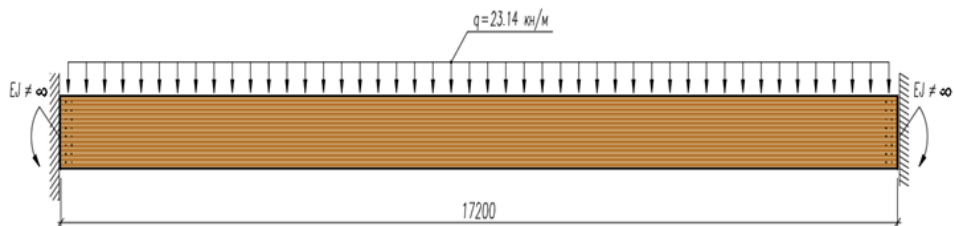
К расчету примера клееной балки с условно жесткими опорами
